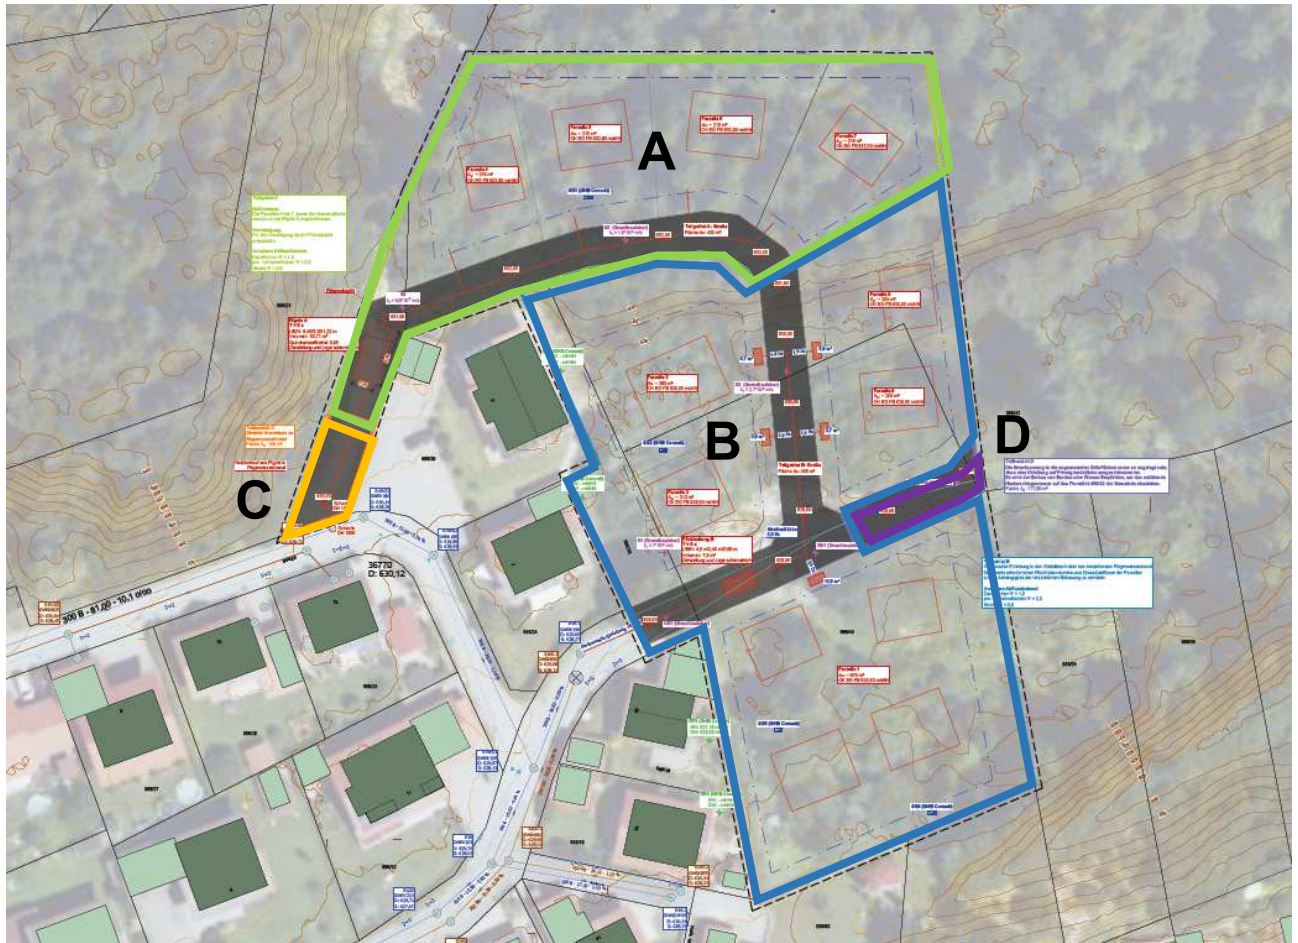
Lageplan Niederschlagswasserbeseitigung (IB Kokai)
